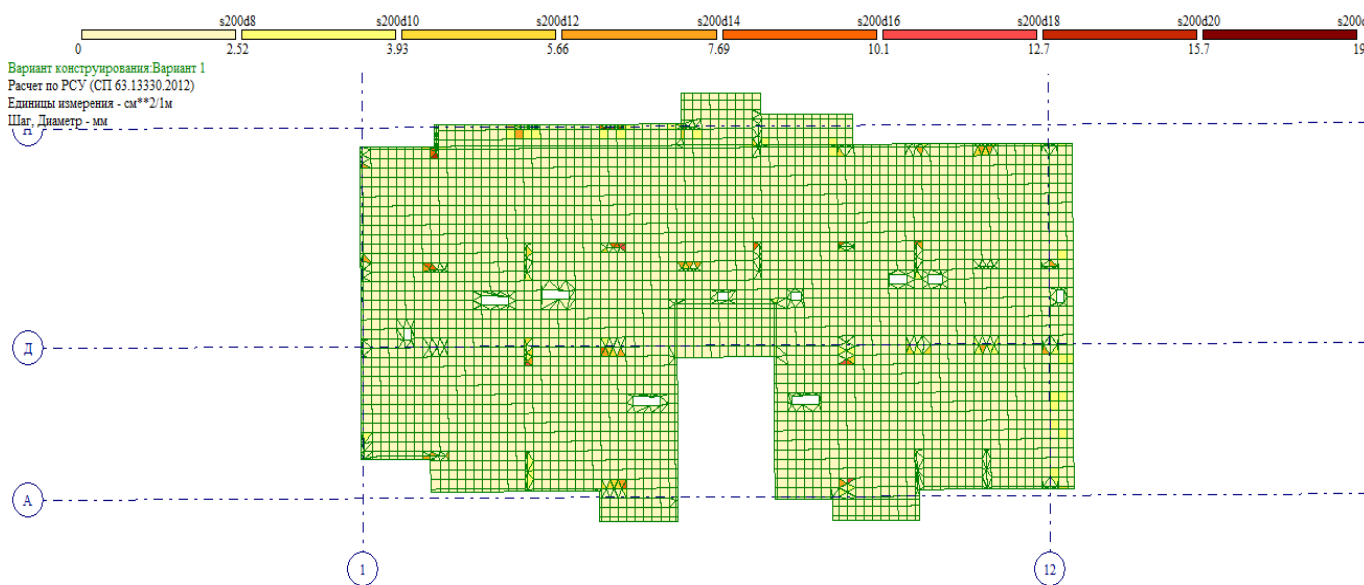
Нижнее армирование плиты по оси Y1
